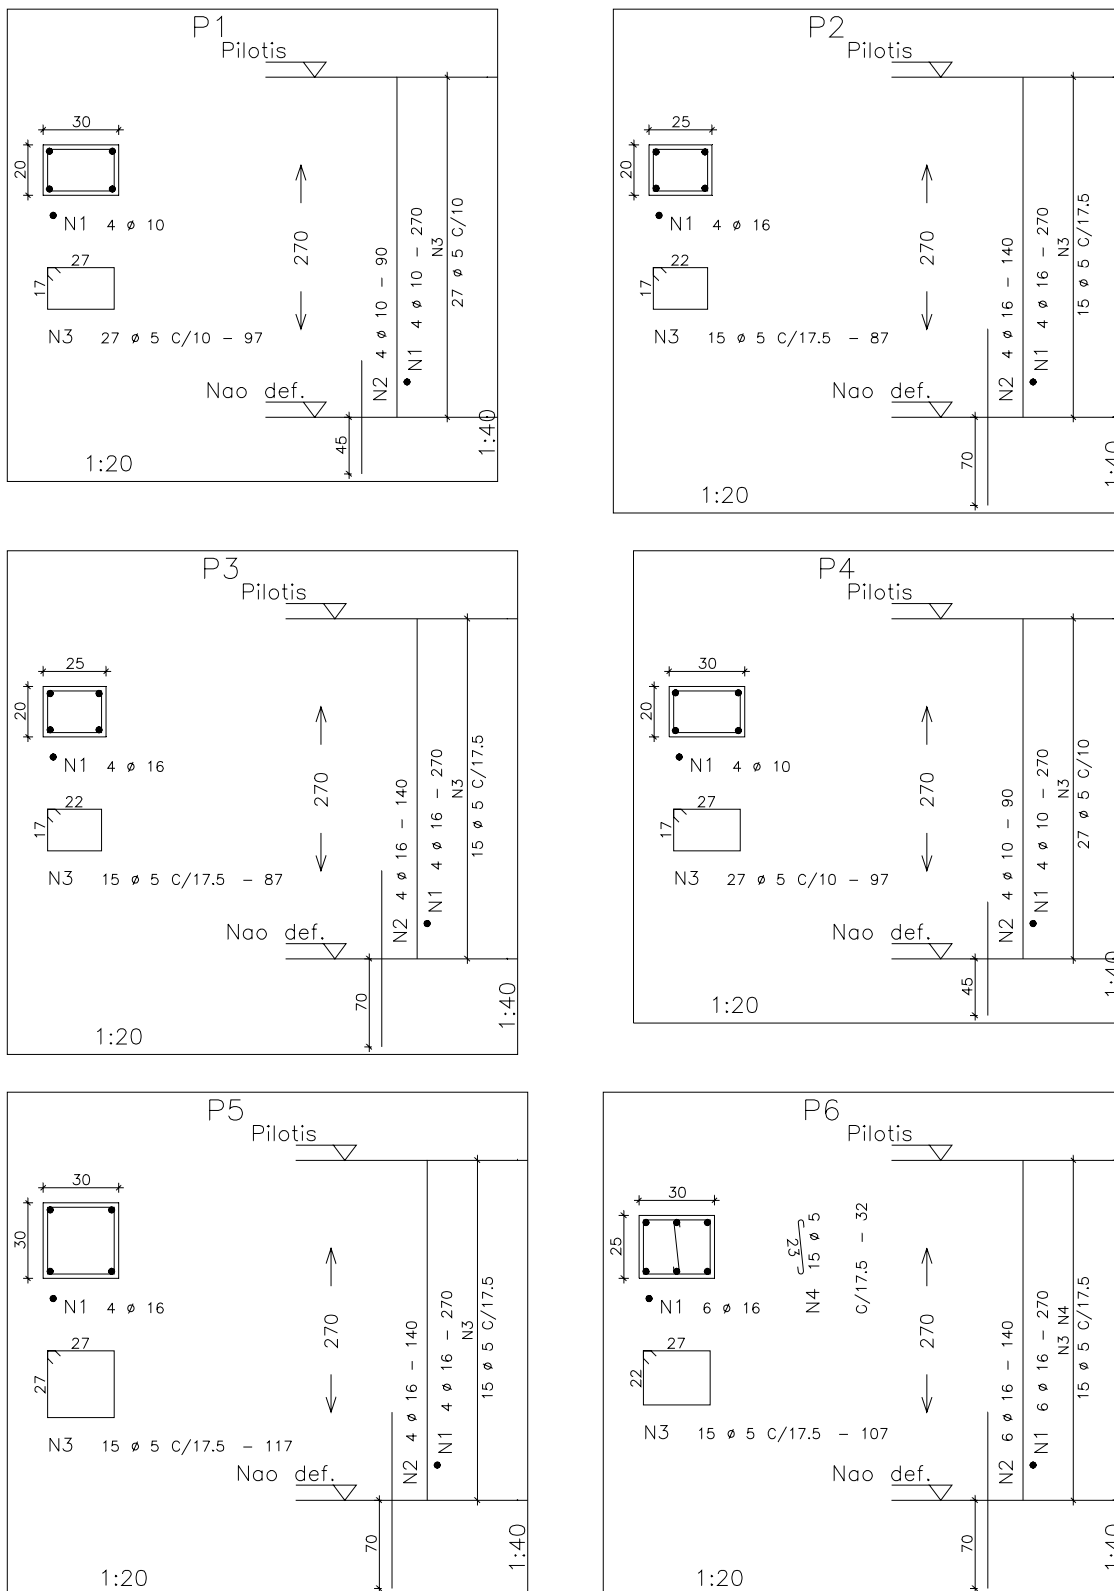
Prédio “C” – Opção 4 – Armação dos pilares P1 a P6
